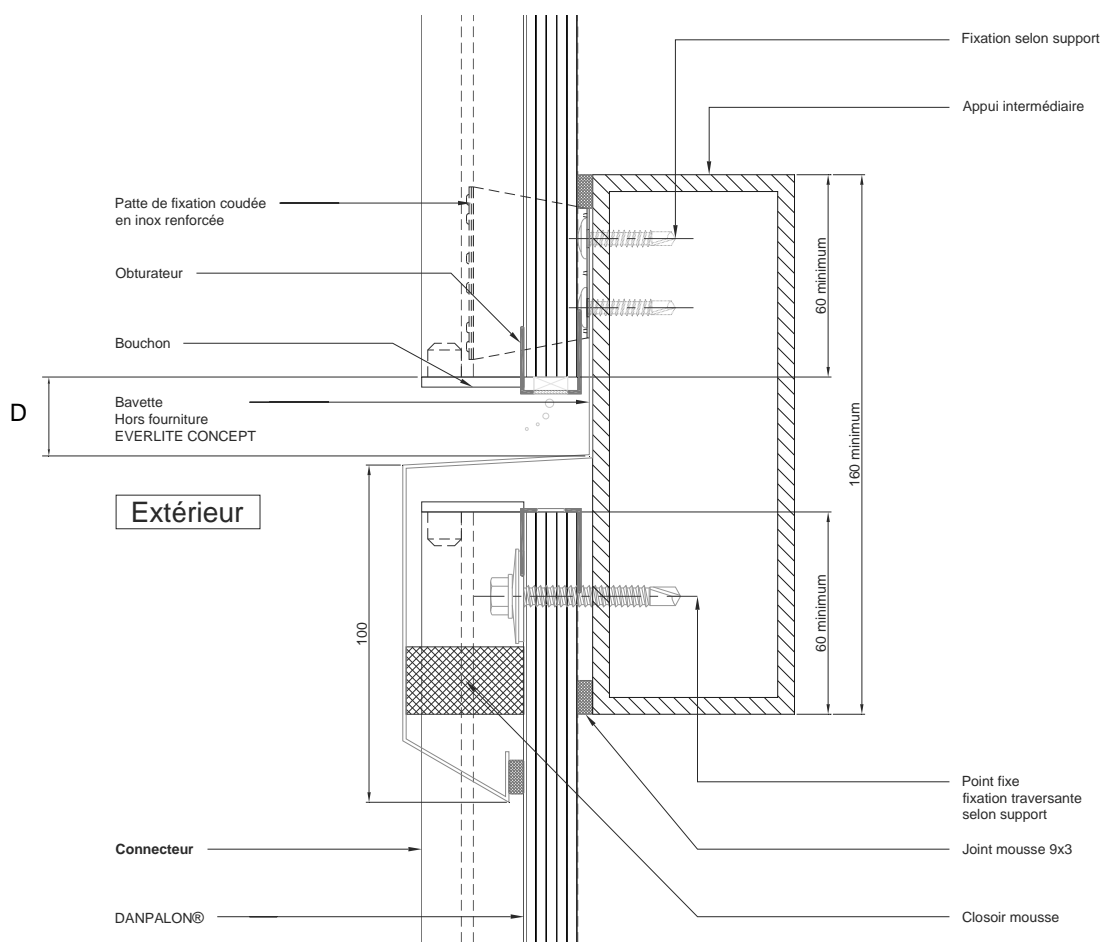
Exemple d'aboutage de panneaux DANPALON® en pose normale
